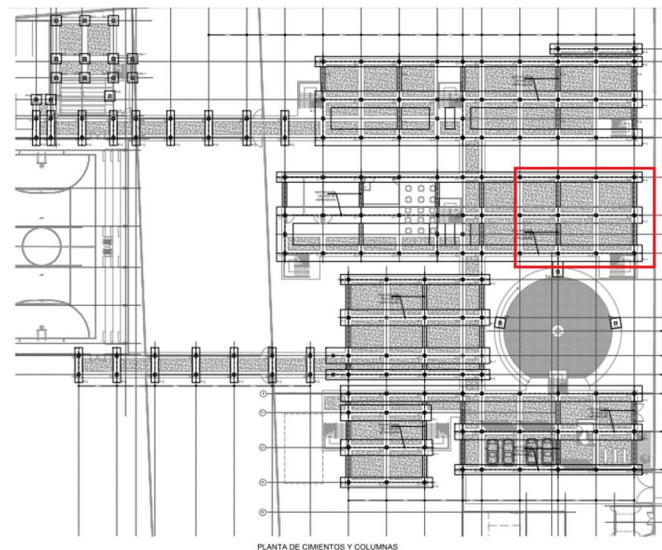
Sección de planta estructural a analizar - Martínez, 2019.
